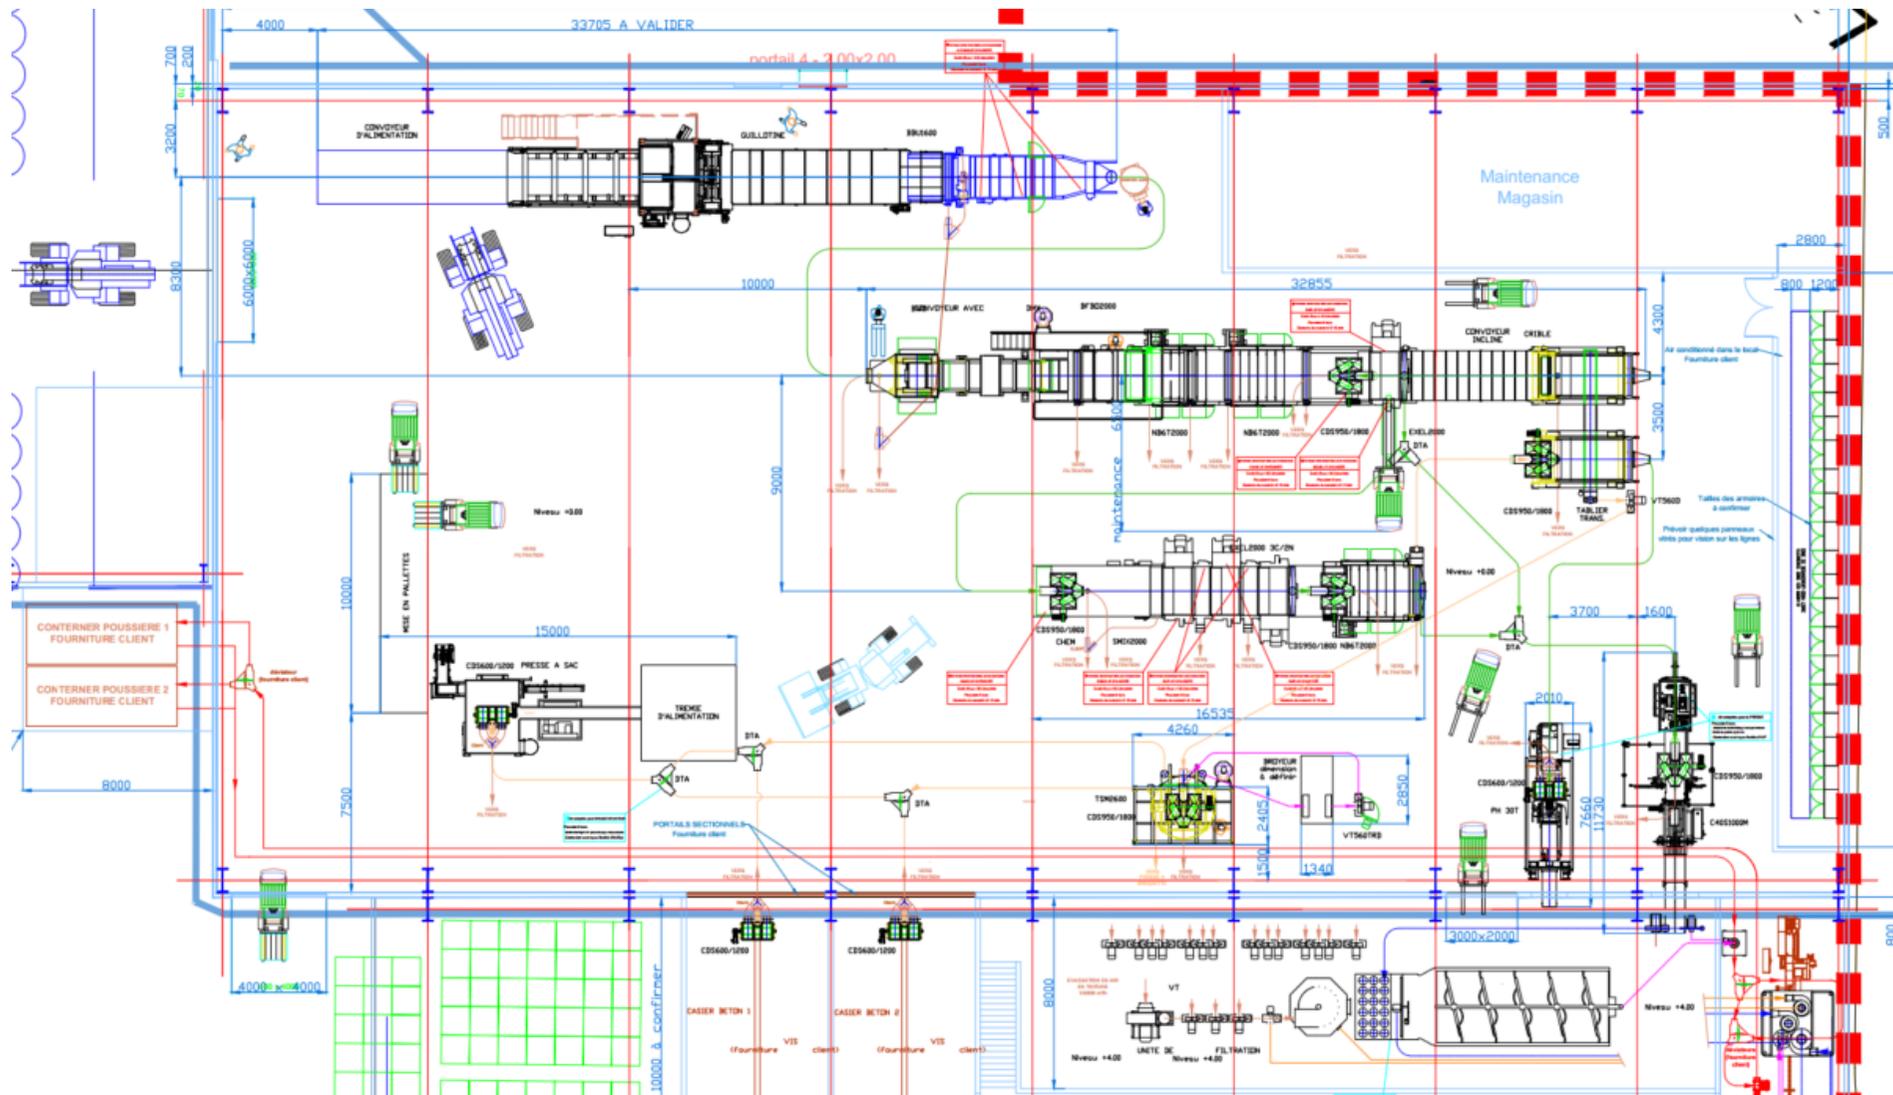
Plan d'implantation des installations dans les bâtiments
